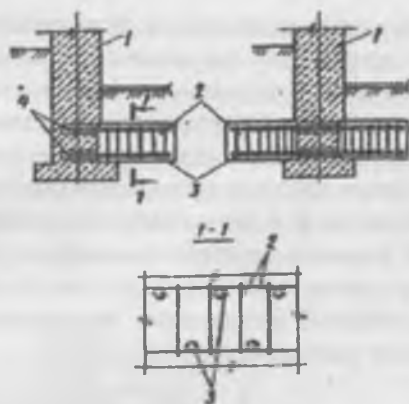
Усиление ленточных фундаментов наращиванием:
